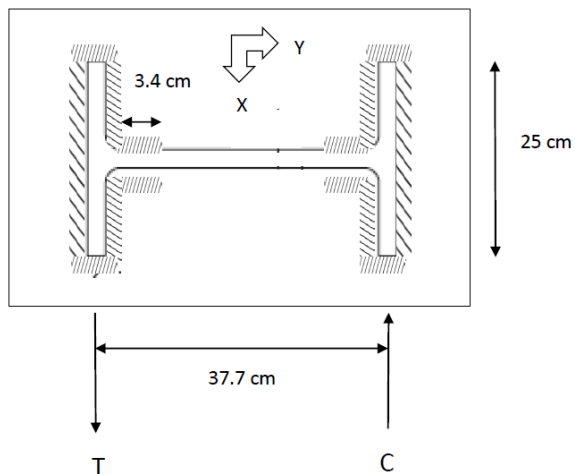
Ubicación de fuerza de tensión para la soldadura de filete entre columna y plancha
